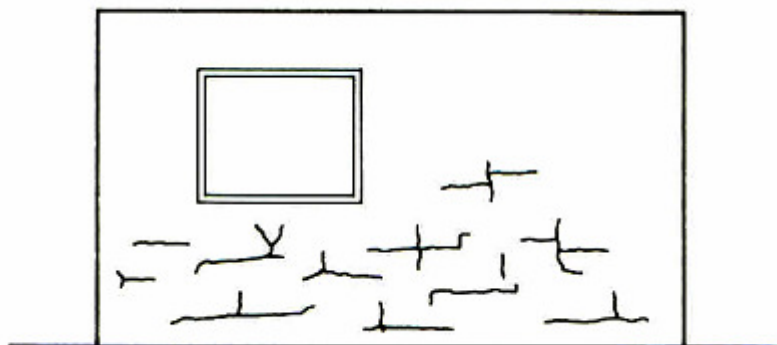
fissuras na argamassa de revestimento provenientes do ataque por sulfatos (THOMAZ, 1989, p. 121)
